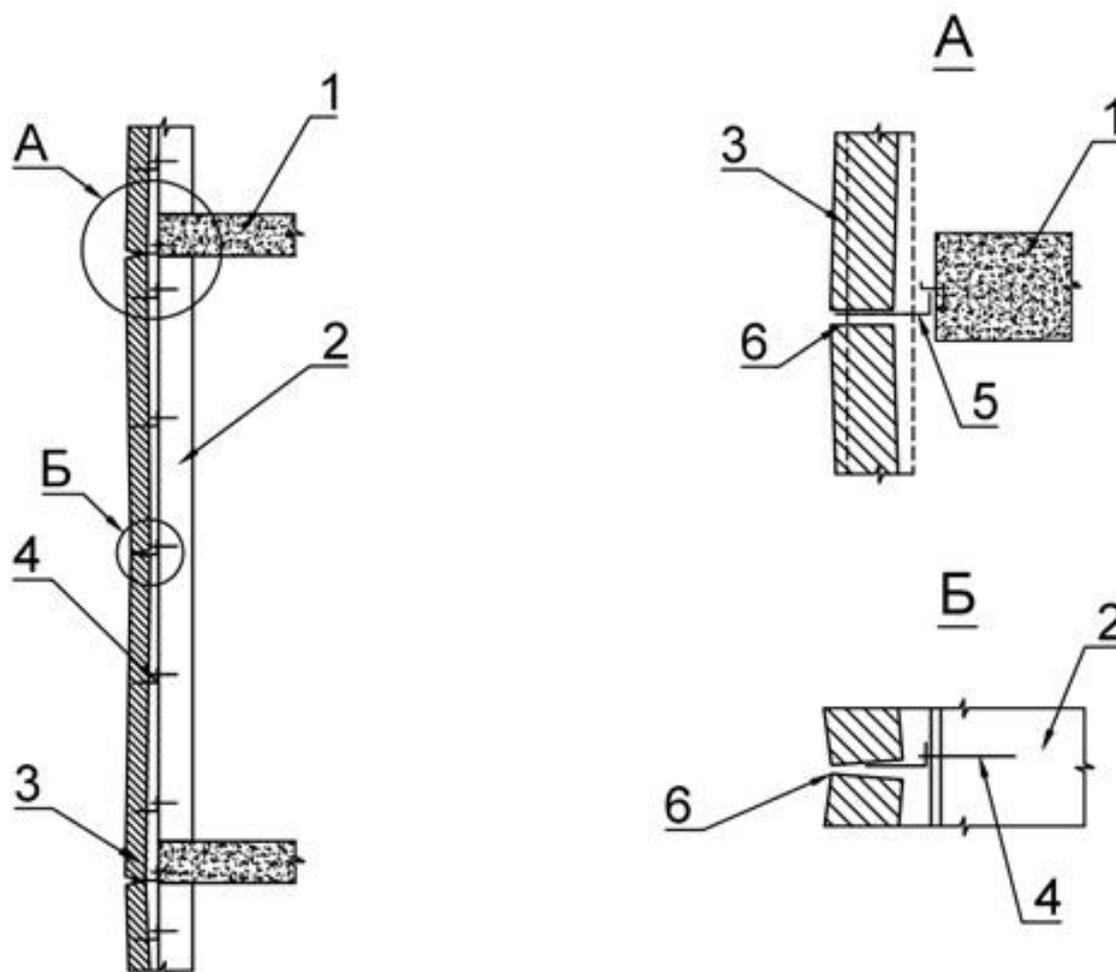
Схема деформирования лицевого слоя, опирающегося на металлические уголки: 1 – плита перекрытия, 2 – внутренний слой, 3 – лицевой кирпичный слой, 4 – горизонтальные анкера, 5 – опорный уголок, 6 – трещина
